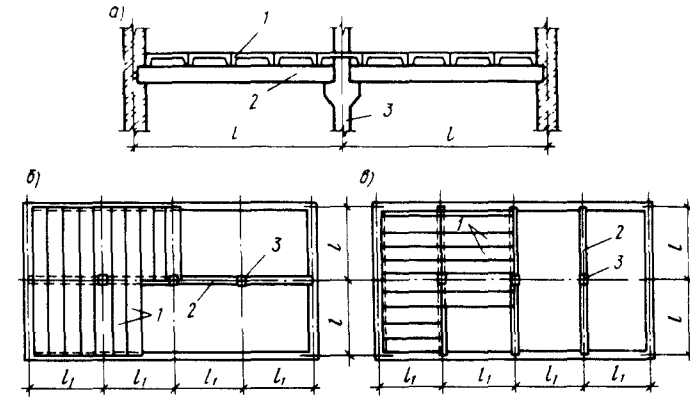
Конструктивные схемы сборных балочных перекрытий: а, в — поперечное расположение ригелей; б — продольное расположение ригелей; 1 — панели перекрытия; 2 — ригели; 3 — колонны
